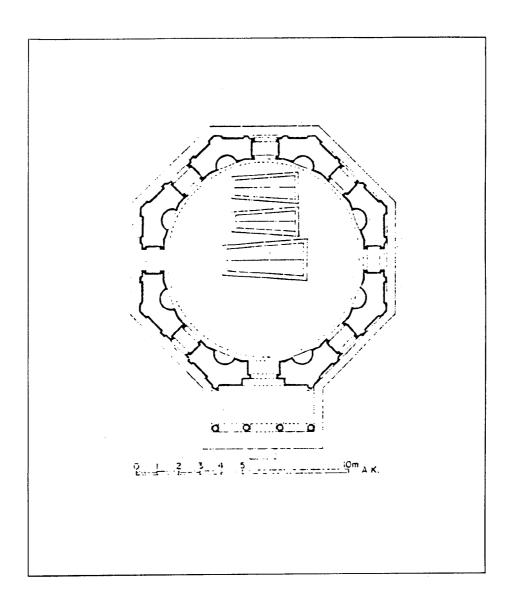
مسقط أفقي لتكية الشيخ سنان في سراييفو (عن :Pašić) .
